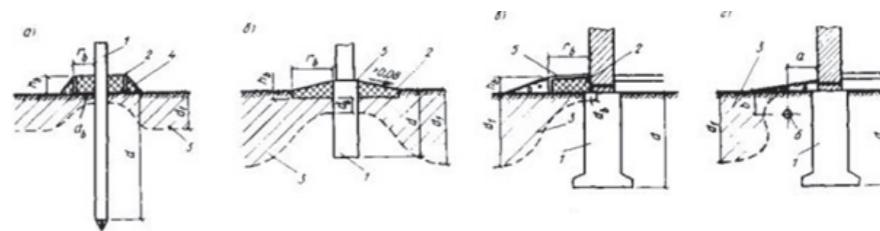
Тепломелиорация грунта у фундамента
